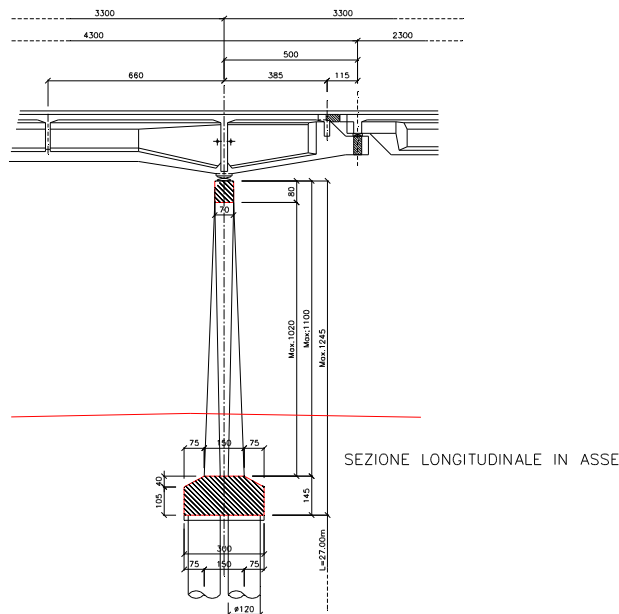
Prospetto e sezioni delle pile - campate da 61,50 m
